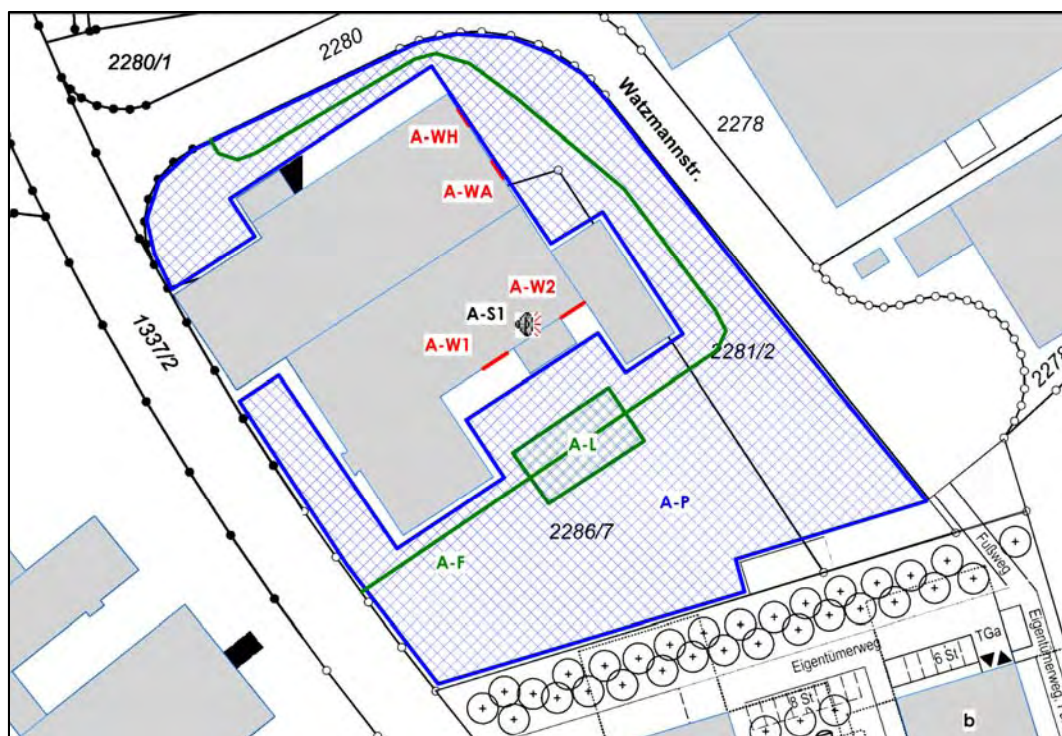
Lageplan mit Darstellung der Schallquellen
